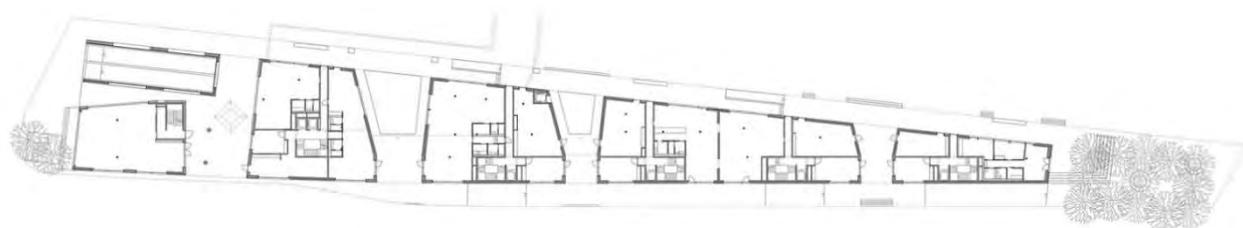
Жилой дом с апартаментами Гринсити, план первого этажа.
